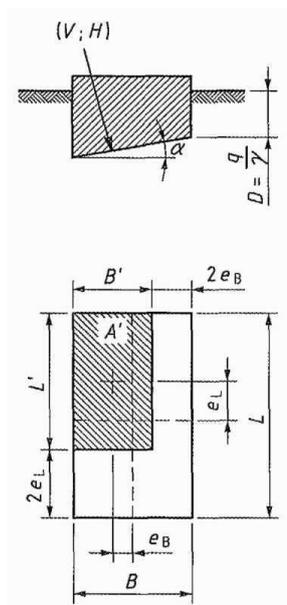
(D1) — Расчетная схема для определения несущей способности основания плитного фундамента по методике Еврокод 7 аналитическим методом с использованием рекомендуемого приложению D
